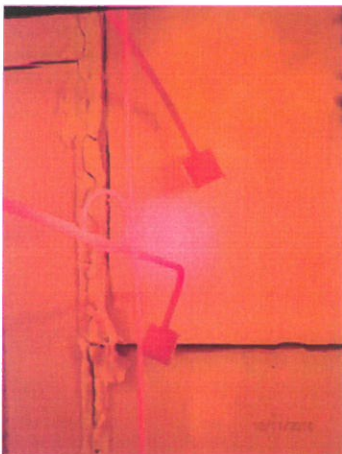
Prüfminute 37: Fugen der Feuerschutzplatten geöffnet, Spachtelmasse herausgefallen.
